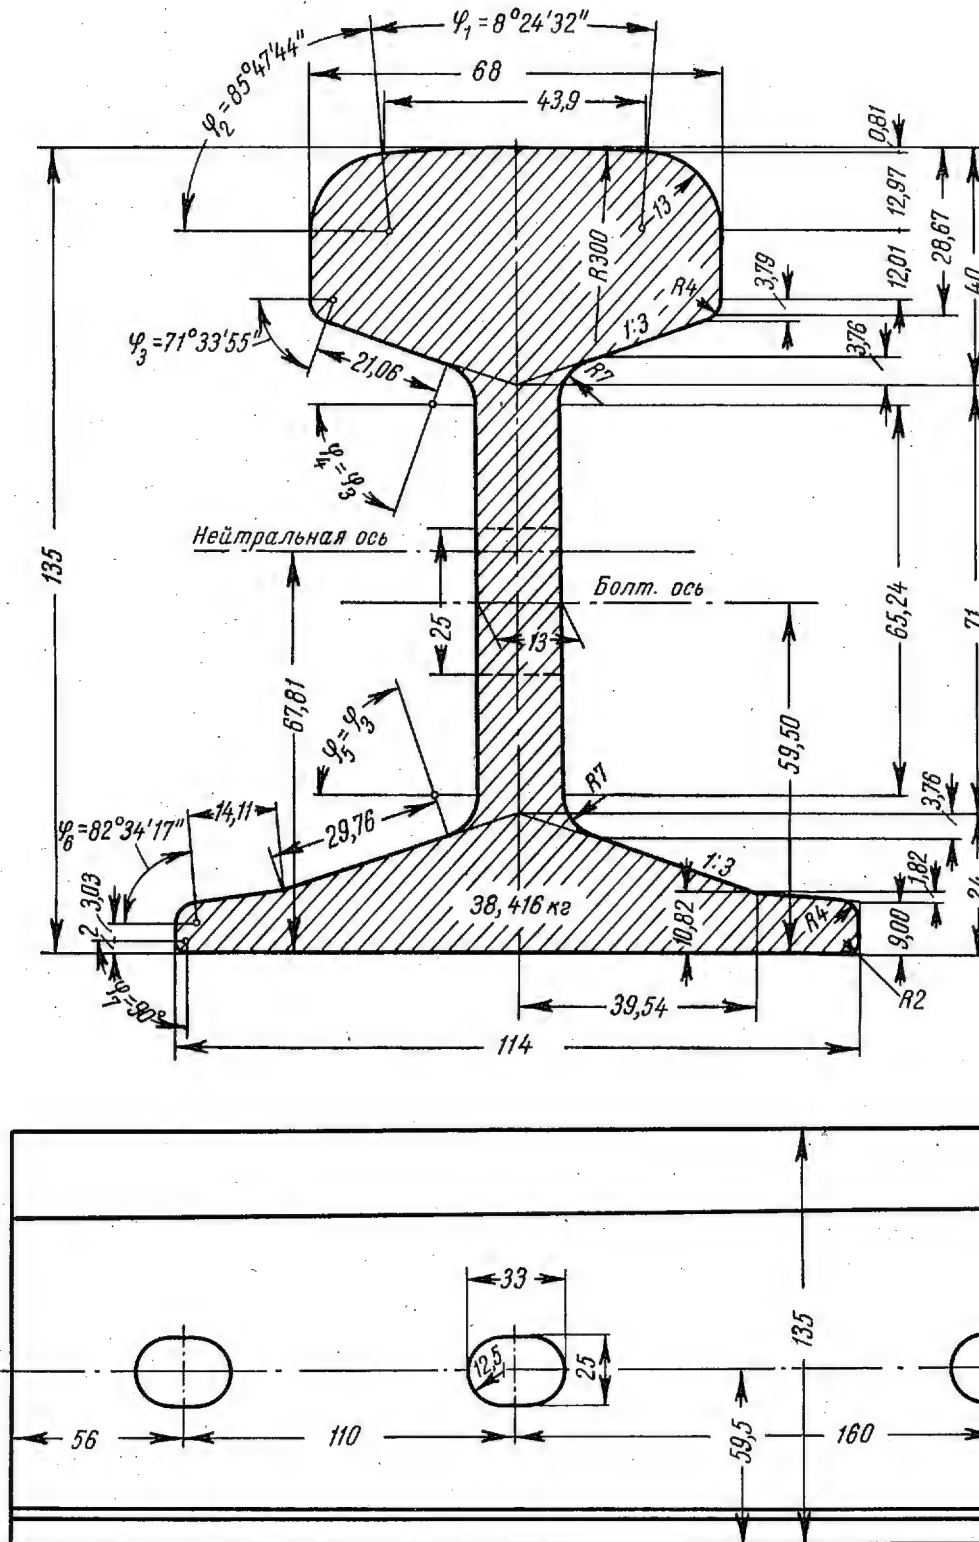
Поперечный разрез и боковой вид конца рельса типа Р 38. Отверстия для болтов могут быть овальными, либо круглыми (ГОСТ 3542-47)
